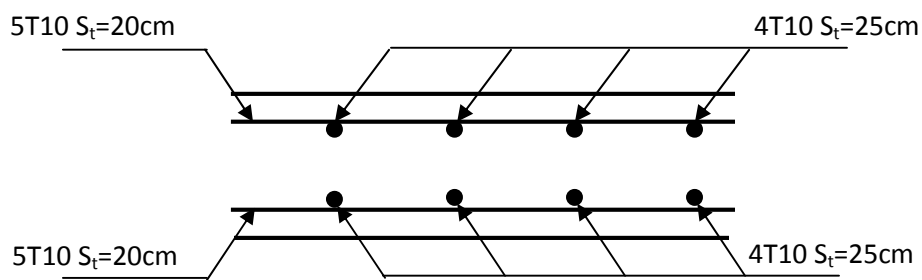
Vue en coupe du ferrailage de la dalle.
